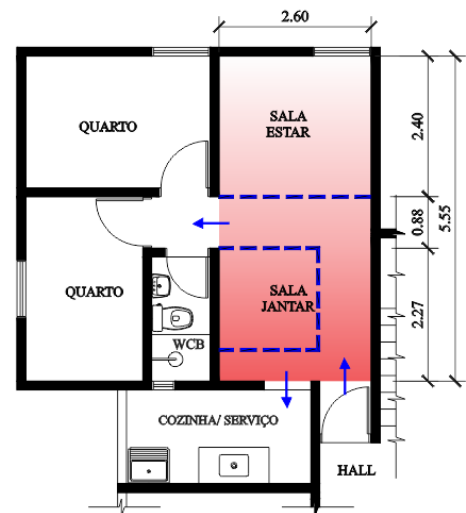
Planta Baixa Pav. Tipo: Setor Social do Residencial Canto dos Pássaros (sem escala)
